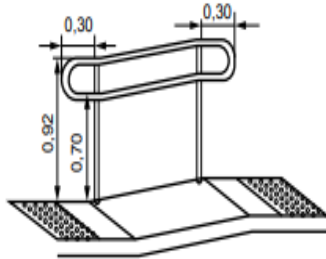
rampas de acesso da ABNT 9050/2015 / rampas de acesso do CERNDR
